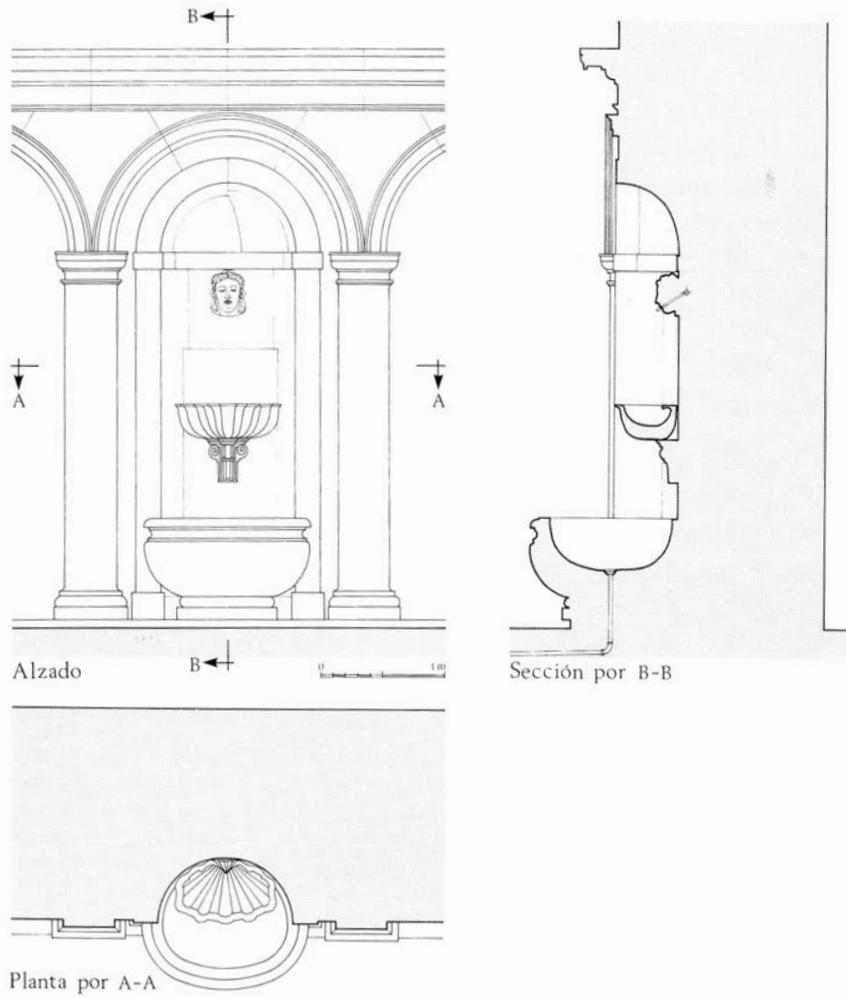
Alzado, planta y sección de la composición de las fuentes.
